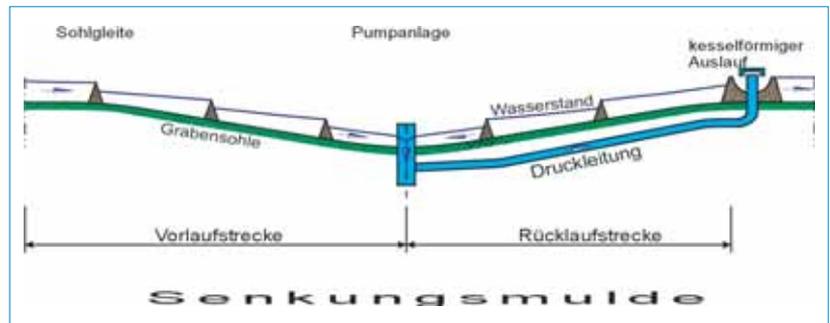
Funktionsschema einer Gewässerpumpanlage
